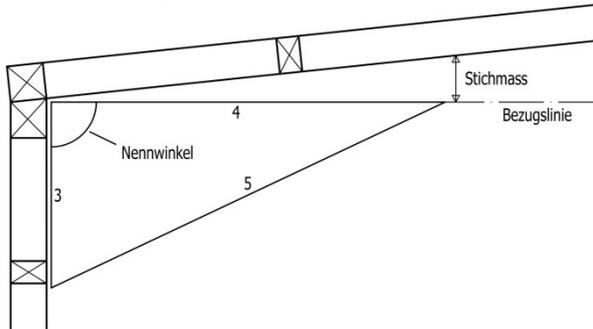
Messung einer Winkelabweichung in einem Grundriss
